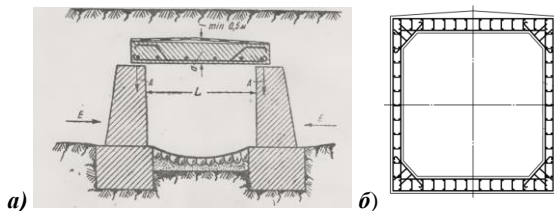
Сечение железобетонной водопропускной трубы: а – с плитным перекрытием; б – рамная конструкция
